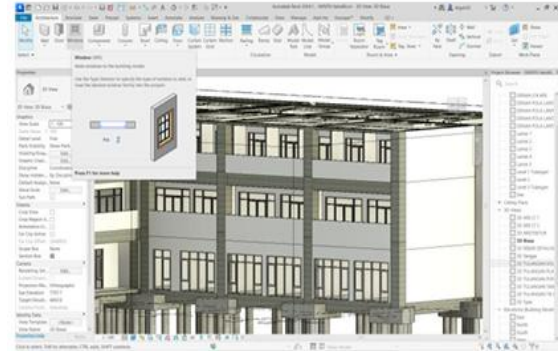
Pemodelan Plat Beton pada Revit 2024
